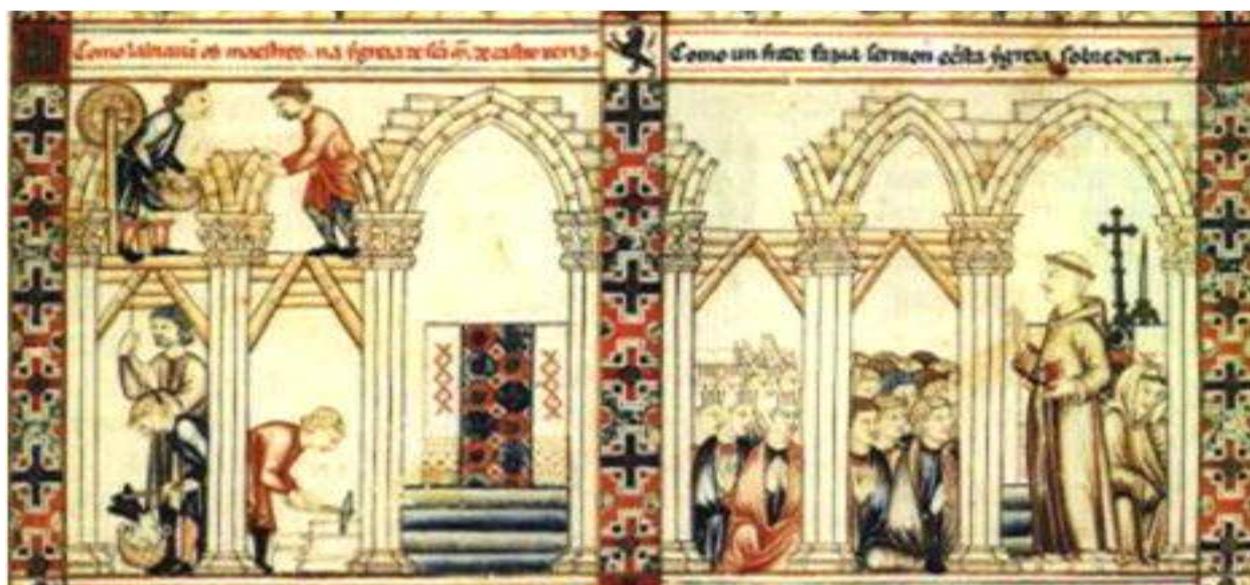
10.3 Cantigas de Santa María, cantiga 266. Detalle fila central.
